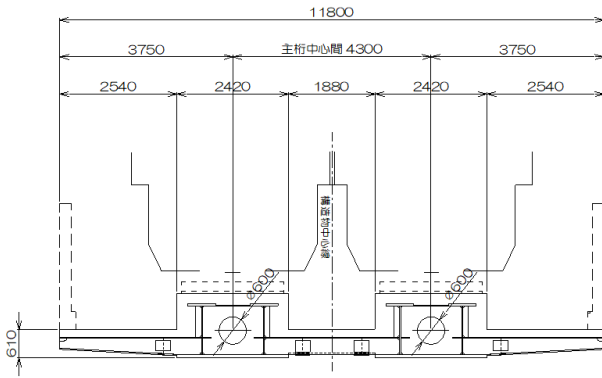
路盤鉄筋コンクリート一体型 SRC 桁の一般図
